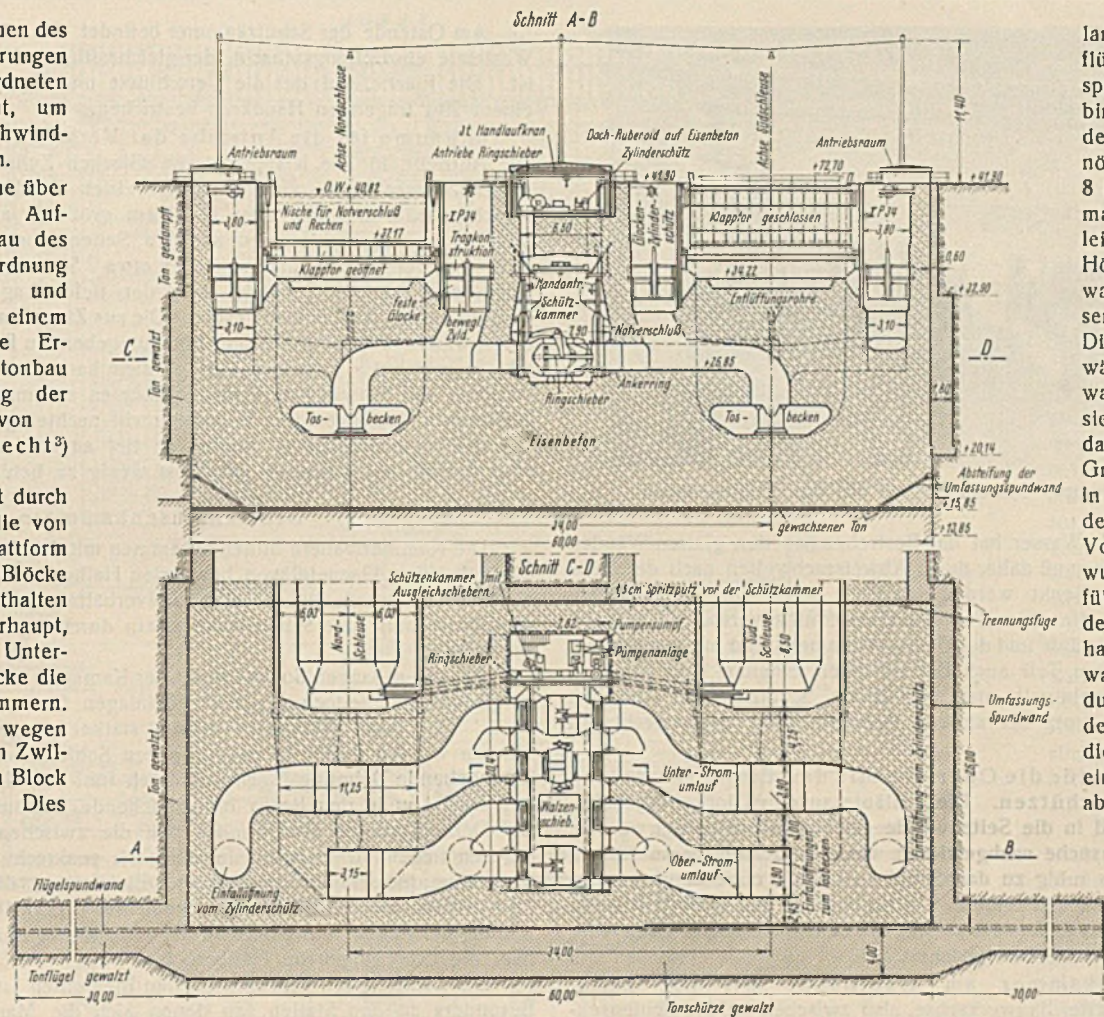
Oberhaupt. Querschnitt und Grundriß.
